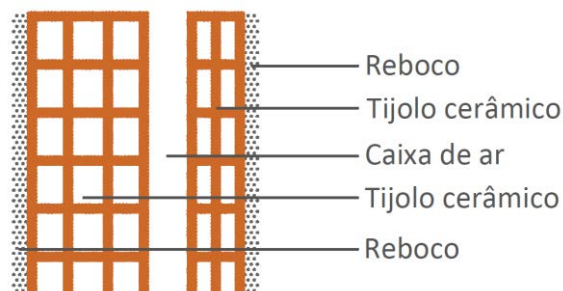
Solução construtiva tipo de parede exterior – Pré intervenção
